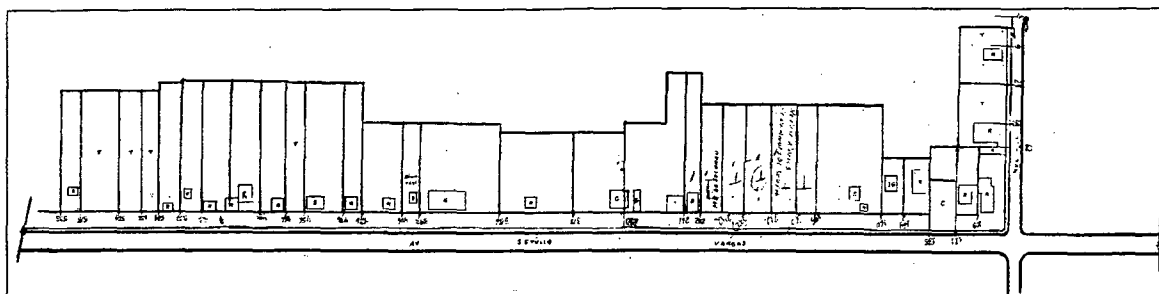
Planta de Quadra, Setor 4 Quadra 249
